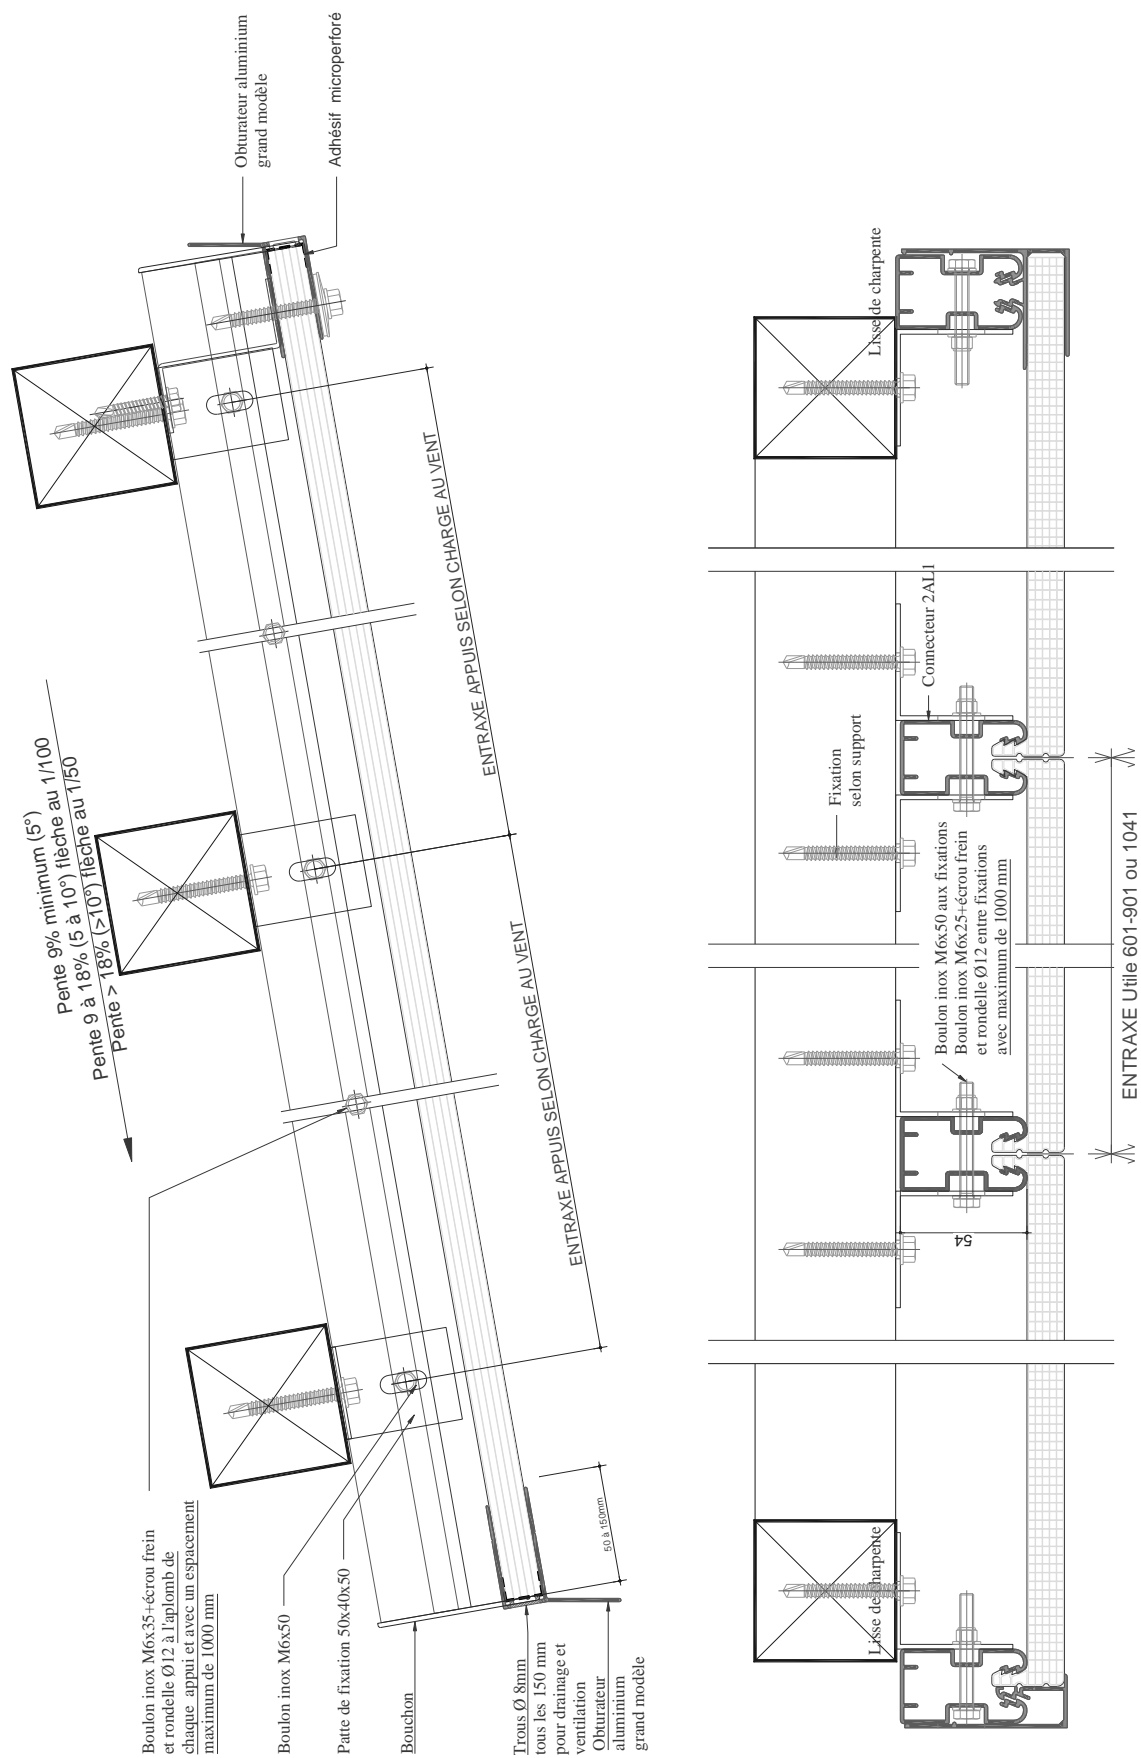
Coupes longitudinale et transversale sur connecteur aluminium 2AL1 – système DANPALON® Couverture suspendue
